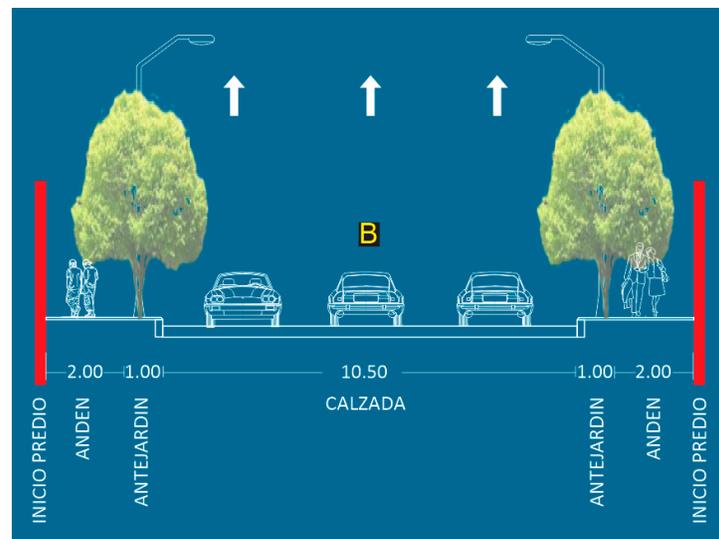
Perfiles Viales aplicables al sector. Fuente: POT Floridablanca 2018, elaboración propia.
